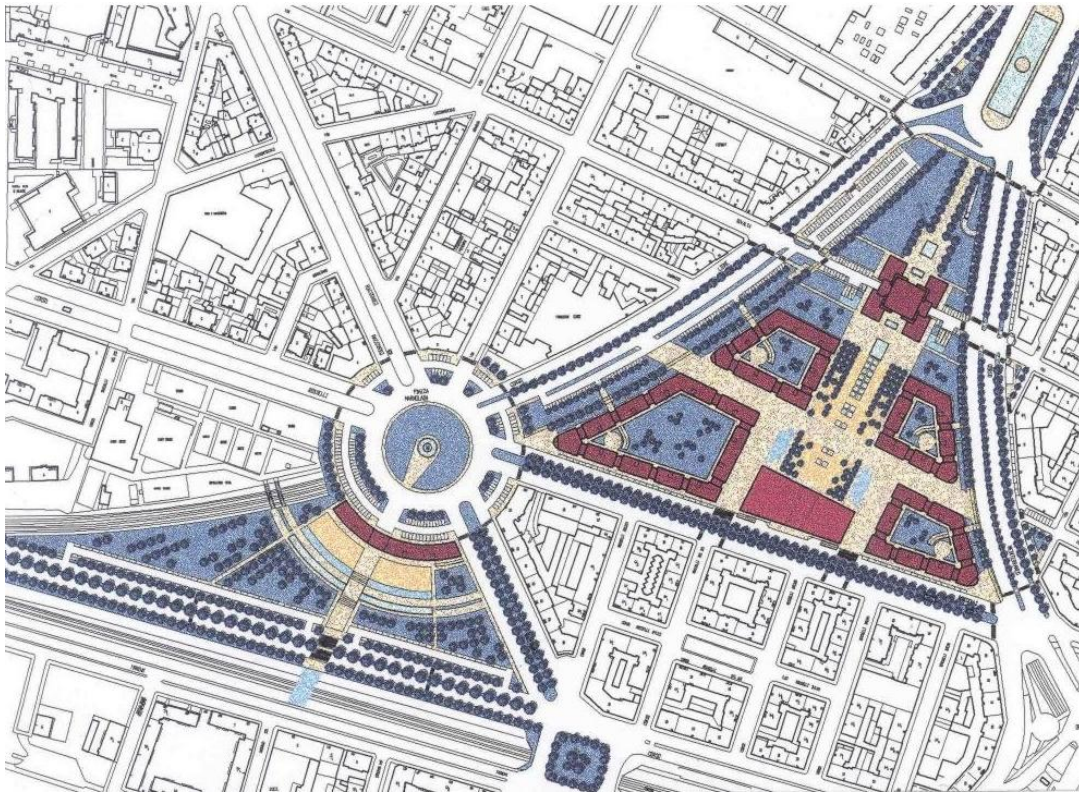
Planimetria generale e profili estratti dal PRIU. (Fonte: per concessione dello Studio Mellano Associati, Torino)
